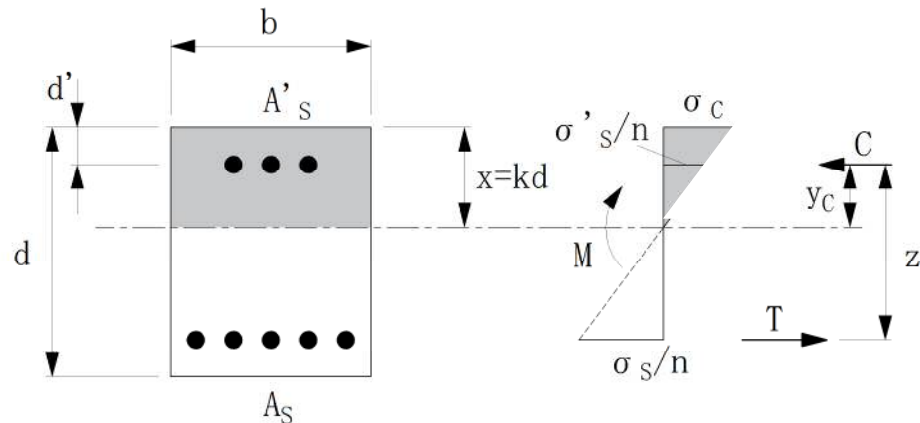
2軸複鉄筋断面の鉄筋コンクリート断面
